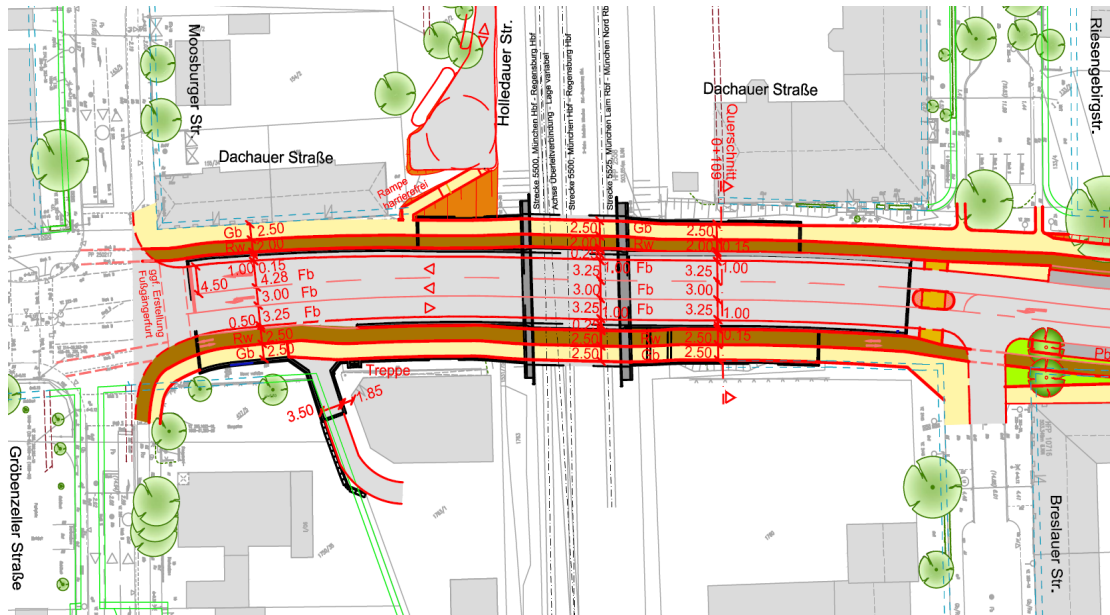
Lageplan Variante 4,50 m lichte Höhe
